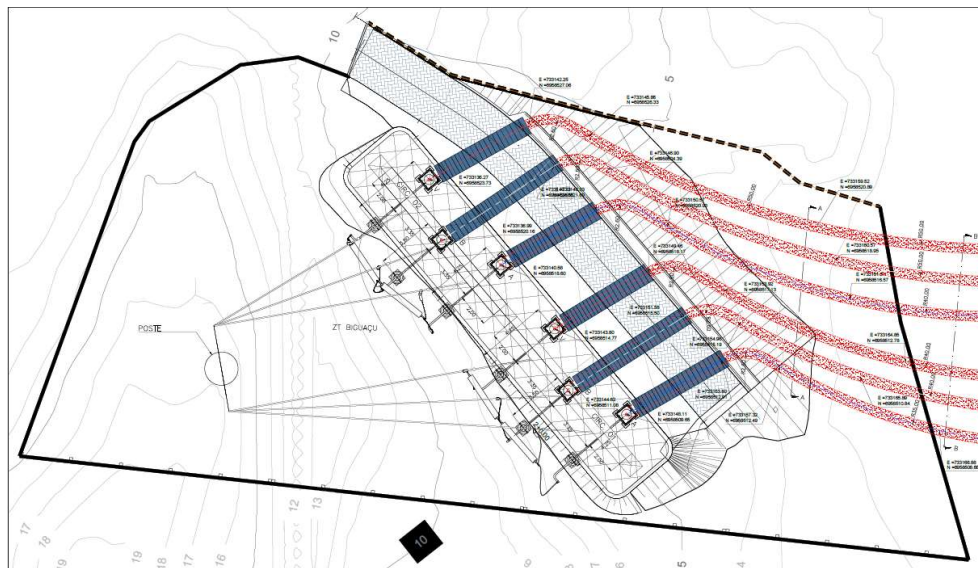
Vista em planta do projeto do arranjo eletromecânico da ZT Biguaçu
